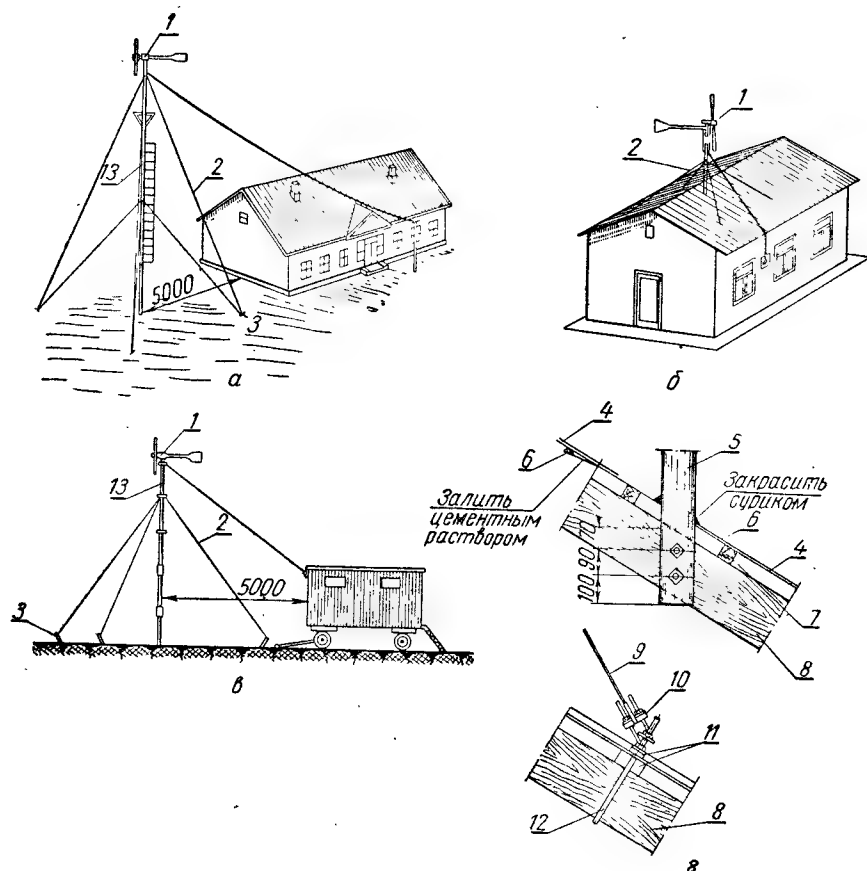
Установка ветроагрегатов ВЭ-2 и ВЭ-2М:
